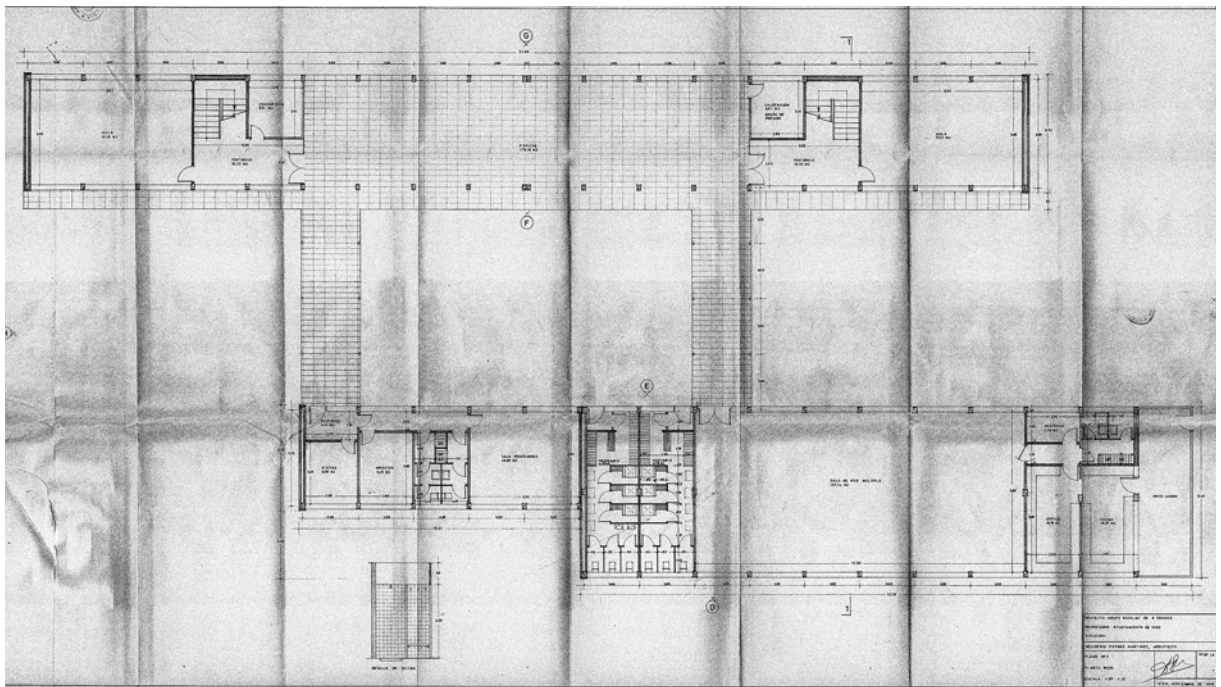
Proyecto de grupo escolar tipo para 8 grados. Planta baja. Noviembre 1968. Imagen: Archivo Histórico. Concello de Vigo.
